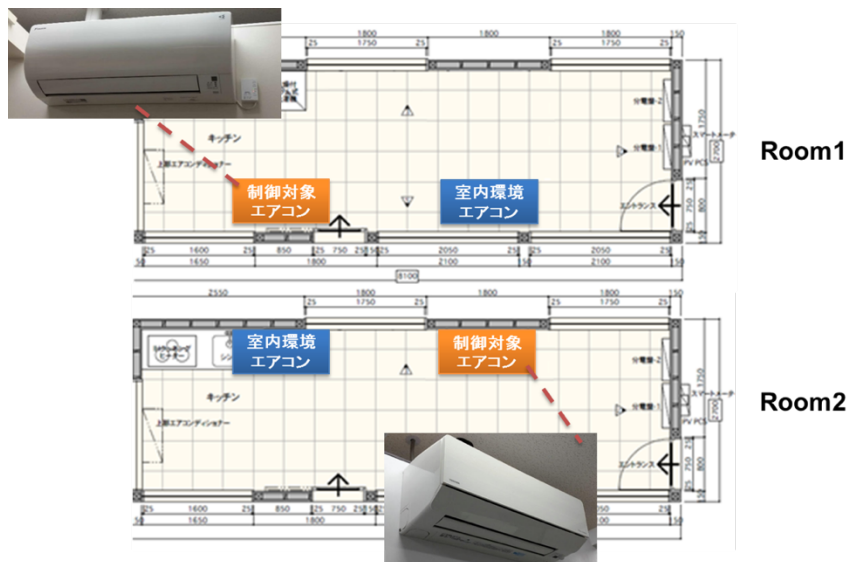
EMS 新宿実証センタースマートハウスの Room1 及び Room2 の平面図
